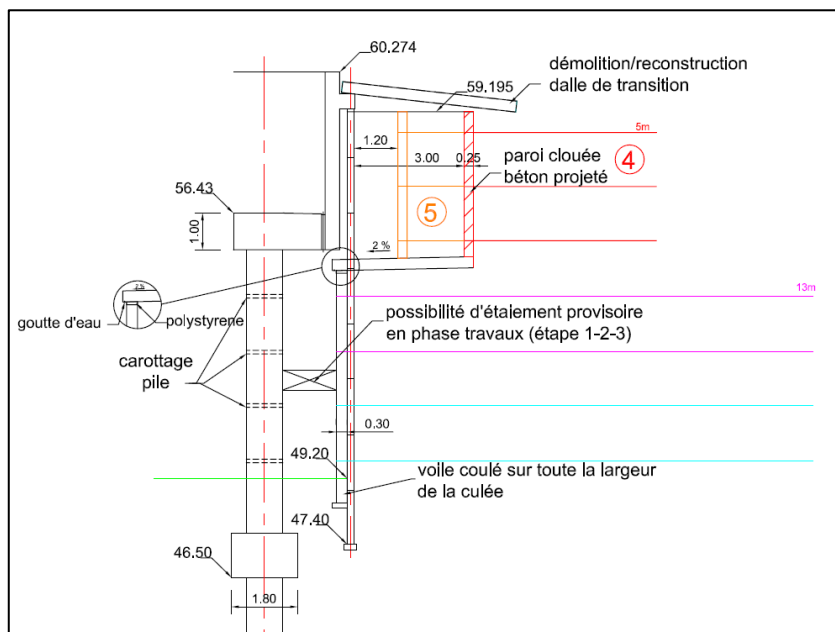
Coupe transversale au droit du mur de front illustrant les problèmes d'encombrement
